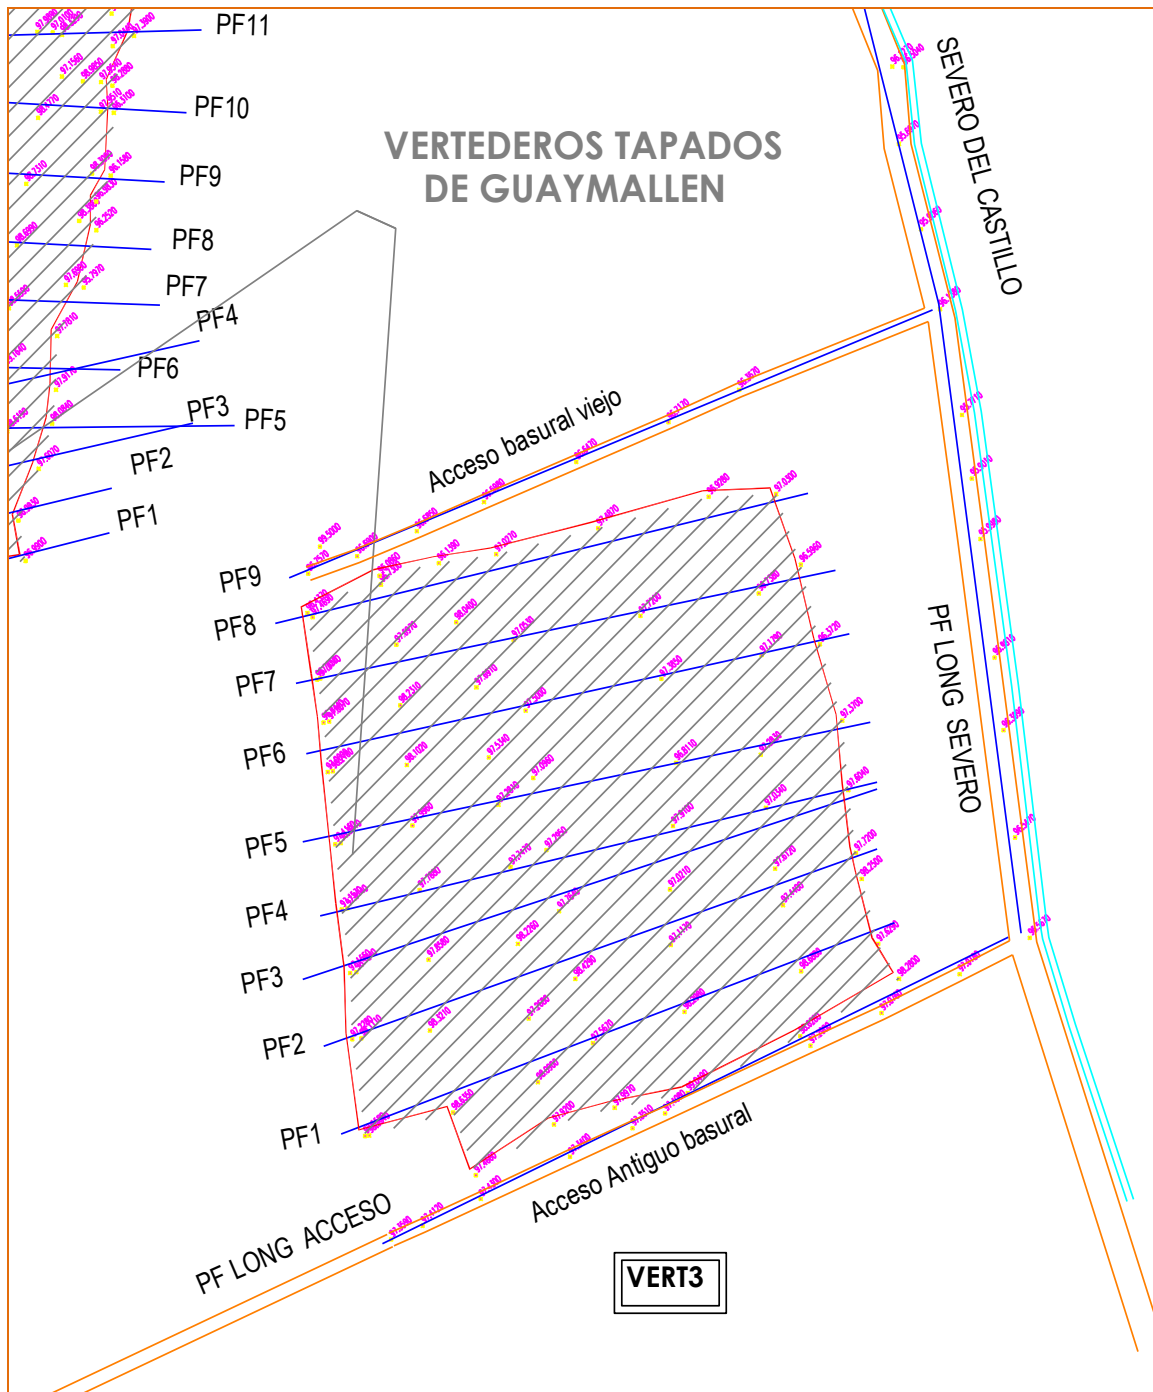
Detalle de la Planimetría Antigua Vertedero de Gllén – Sector Sureste - VERTEDERO Nº3
